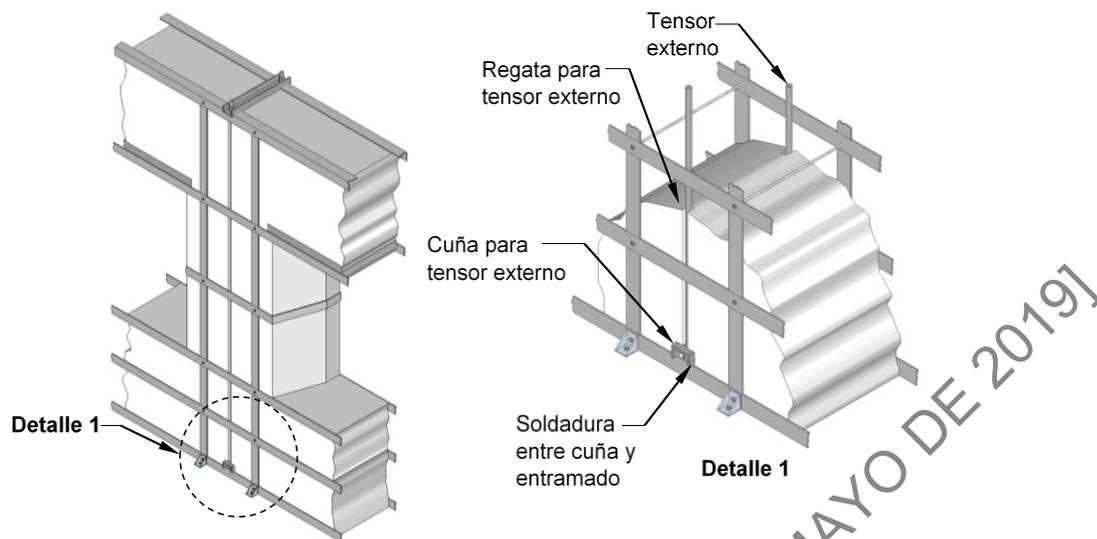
Tensores verticales externos sin anclaje a la cimentación.
